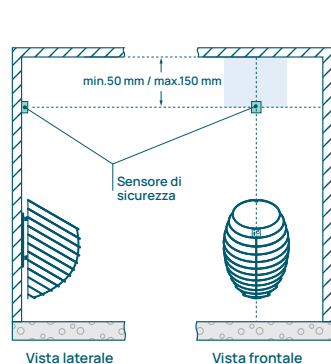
Installazione del sensore di sicurezza a parete: riscaldatore a parete
